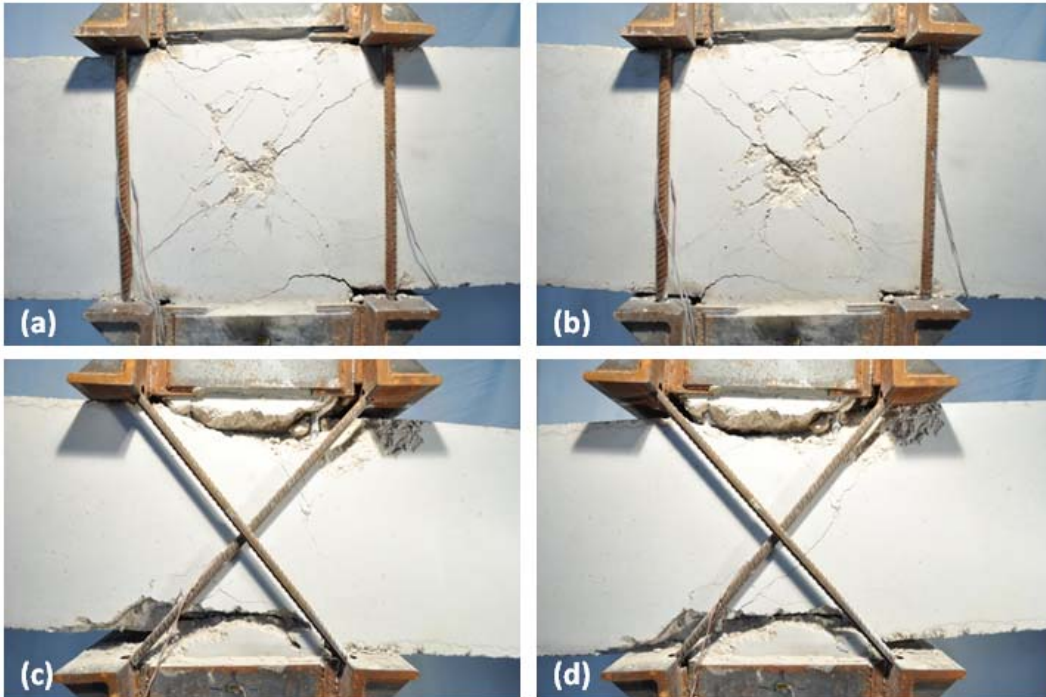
Modos de fallo probetas Tipo S: a,b) probetas reforzadas con barras verticales (Drift +/- 4%), c,d) probetas reforzadas con barras diagonales (Drift +/- 6%)
